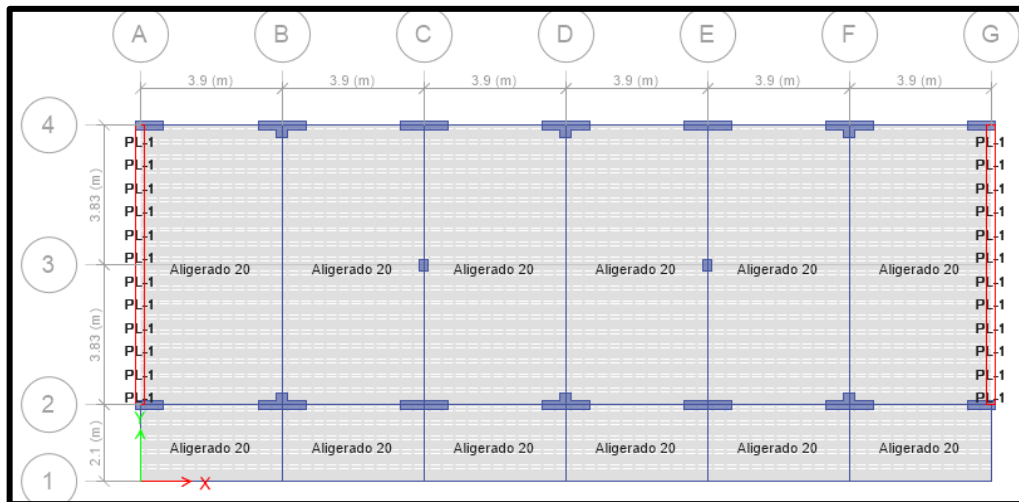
Dibujo del Elemento Estructural Losa Aligerada.
